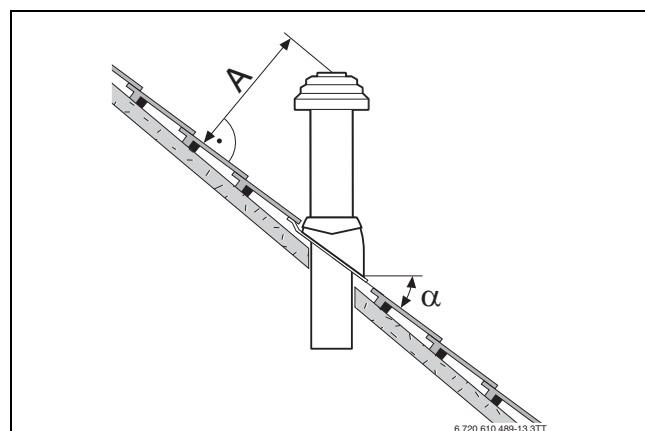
Abstandsmaße und Dachneigungen bei Schrägdach
